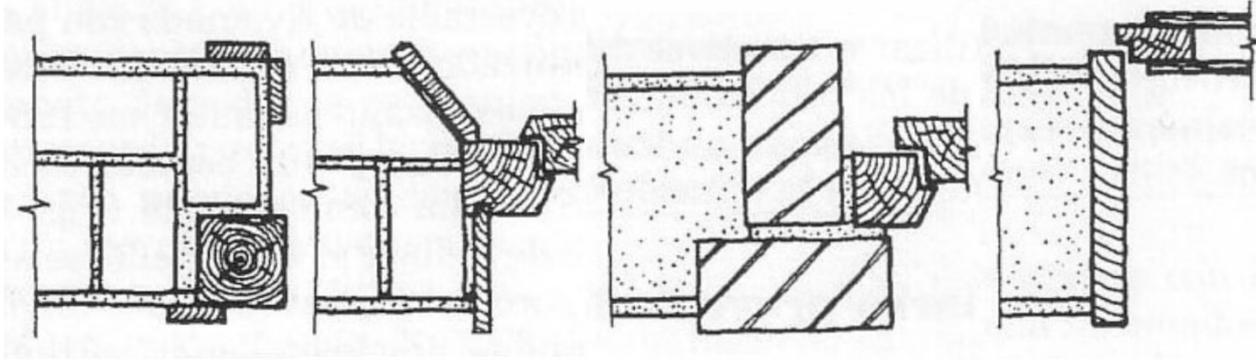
Protección de aristas con elementos rígidos. ²⁴
